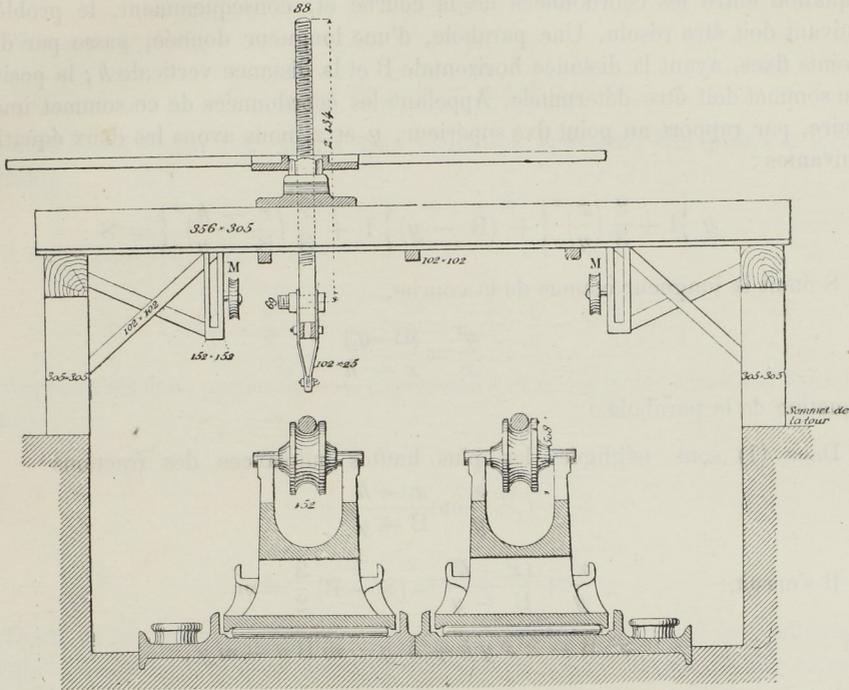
Coupe transversale. — Pose des faisceaux sur les selles.
